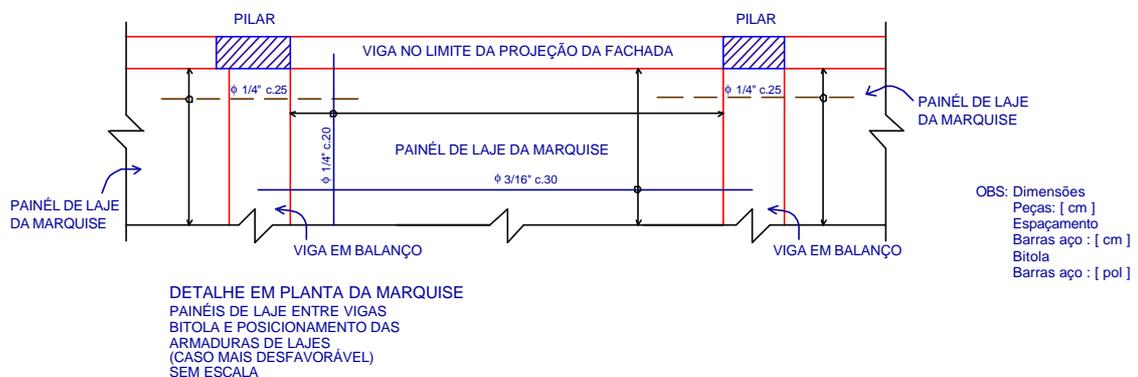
Posição de armaduras em planta referido às peças em concreto.
